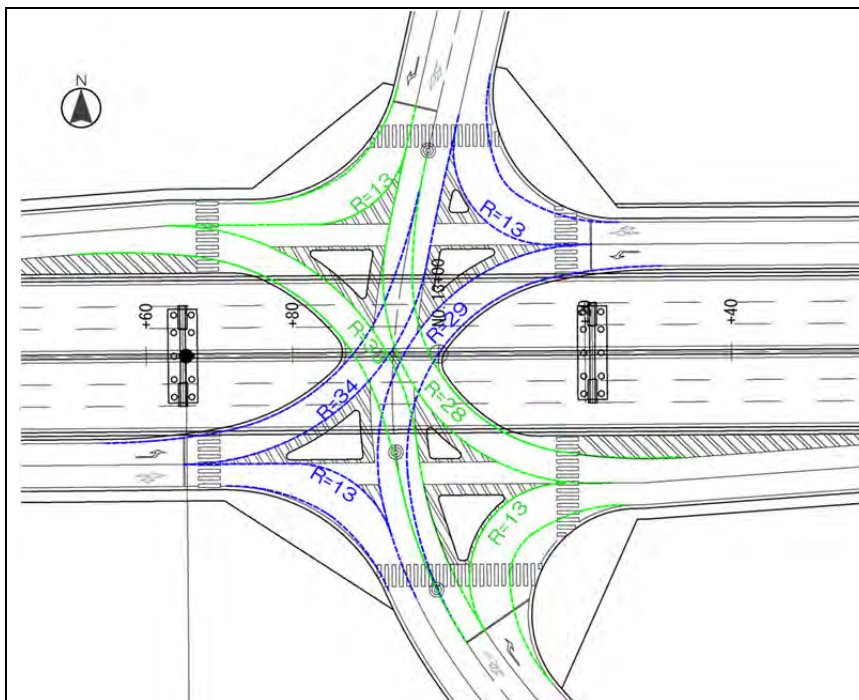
Carrefour Palmeraie Plan de masse du côté ouest (demande de l'AGEROUTE)
